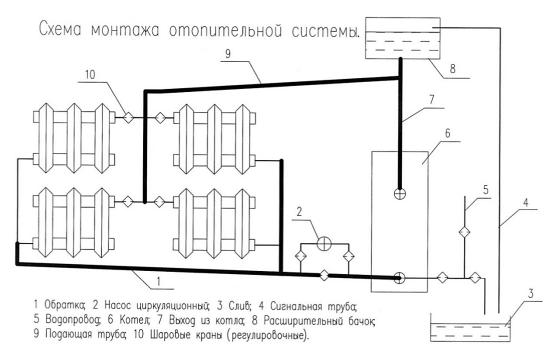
Схема монтажа отопительной системы с использованием циркуляционного насоса
